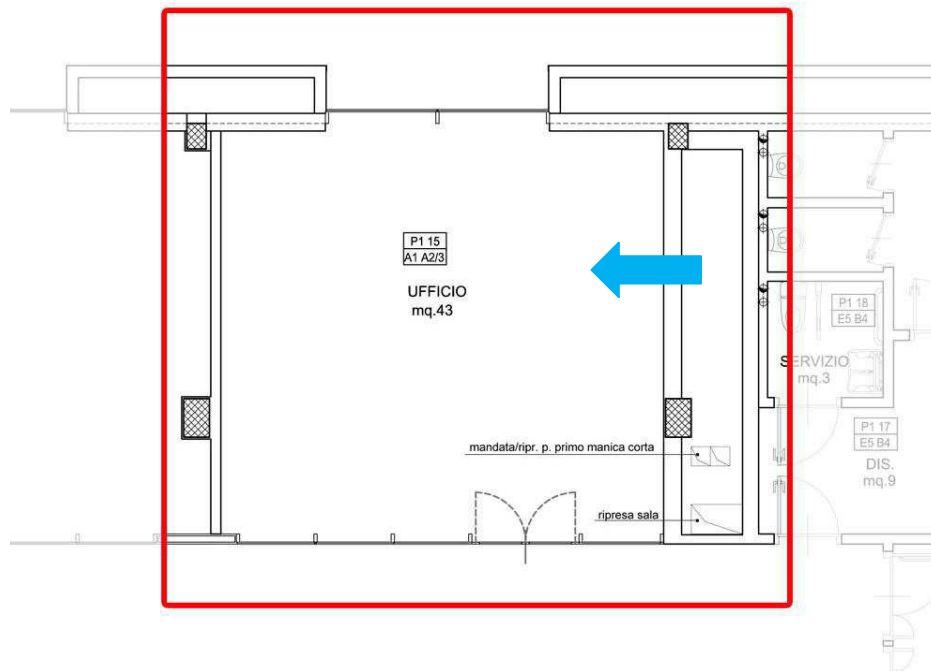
Pianta primo piano con individuazione della parete analizzata.
